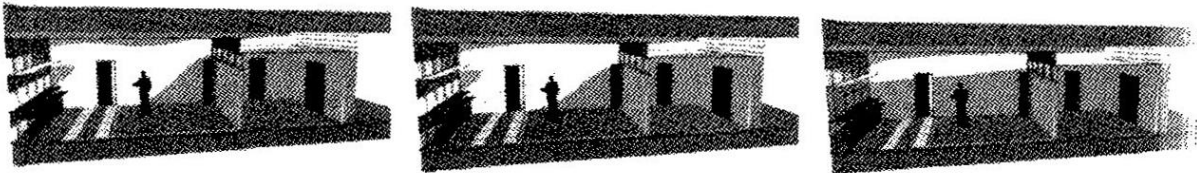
Aberturas para ventilação – Opção 1, 2 e 3, respectivamente.
